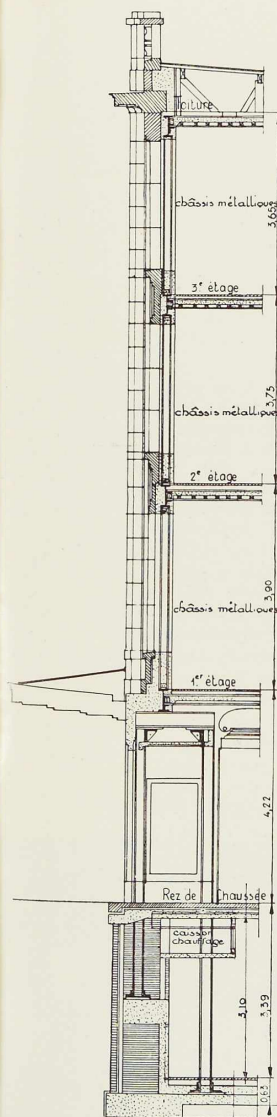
Coupe dans la façade place Verte. On notera les deux colonnes formant cavalier au rez-de-chaussée.
